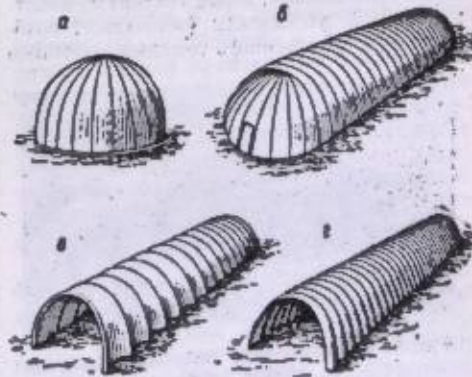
Схемы пневматических строительных конструкций: а — воздухоопорный купол; б — воздухоопорный свод; в — пневмокаркасный свод с несущими пневмоарками; г — пневмокаркасный свод с двойной оболочкой, соединенной диафрагмой.
